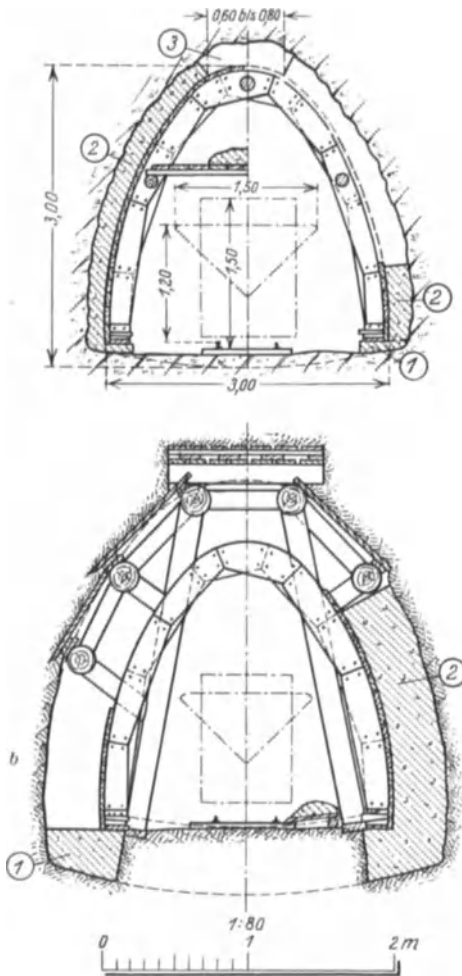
Querschnitte mit Arbeitsvorgang vom Stollen Aistaig. (Bautechn. 1927.) *a* Felsstrecke. 1 Betonierung der Fundamente und Aufstellung der hölzernen Schalbogen. 2 Einbringen des Widerlagerbetons in radialen Lagen von 15 bis 20 cm. 3 Betonieren des Gewölbes vor Kopf. *b* Druckstrecke. 1 Einbringen des Fundamentbetons und Aufstellen der hölzernen Schalbogen. 2 Betonieren der Widerlager, Abstützen der Unterzüge auf die Schalung.
